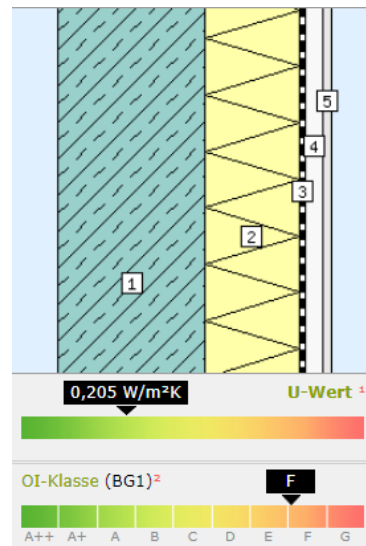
zweite Variante des Bauteilaufbaus, hinterlüftete Stahlbeton-Wand
